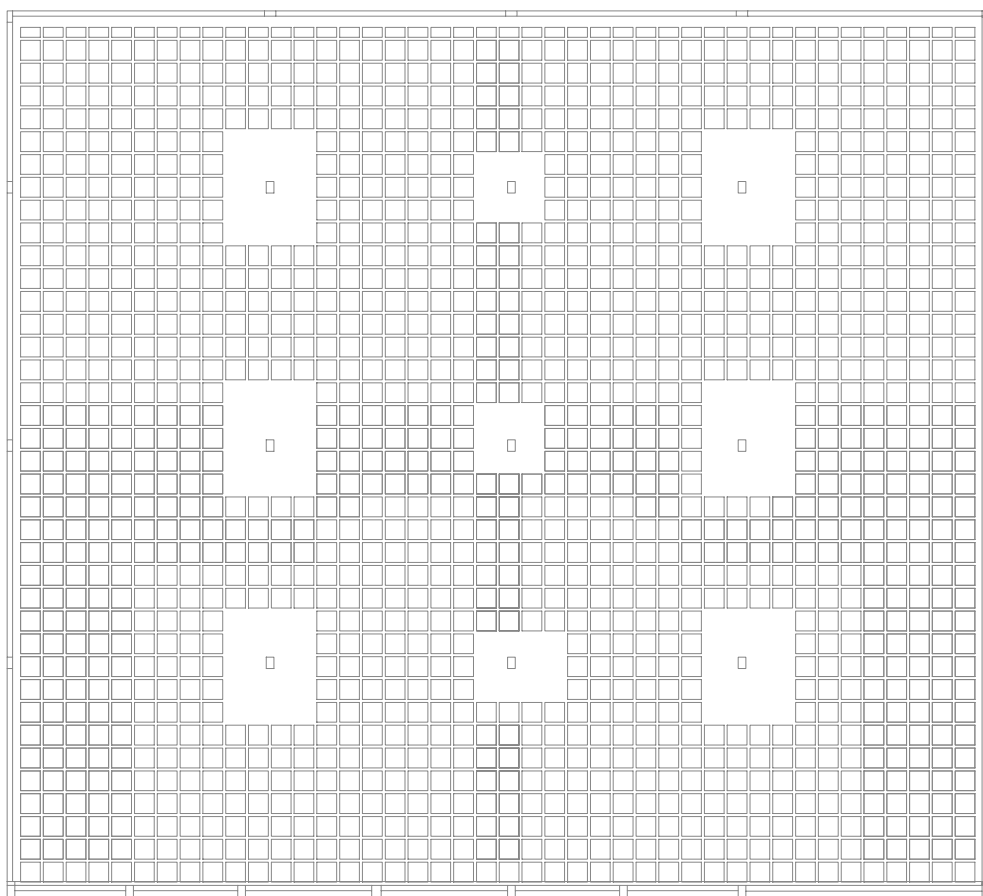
Pavimento: laje nervurada sem vigas - propriedade TECSOFT LTDA.
